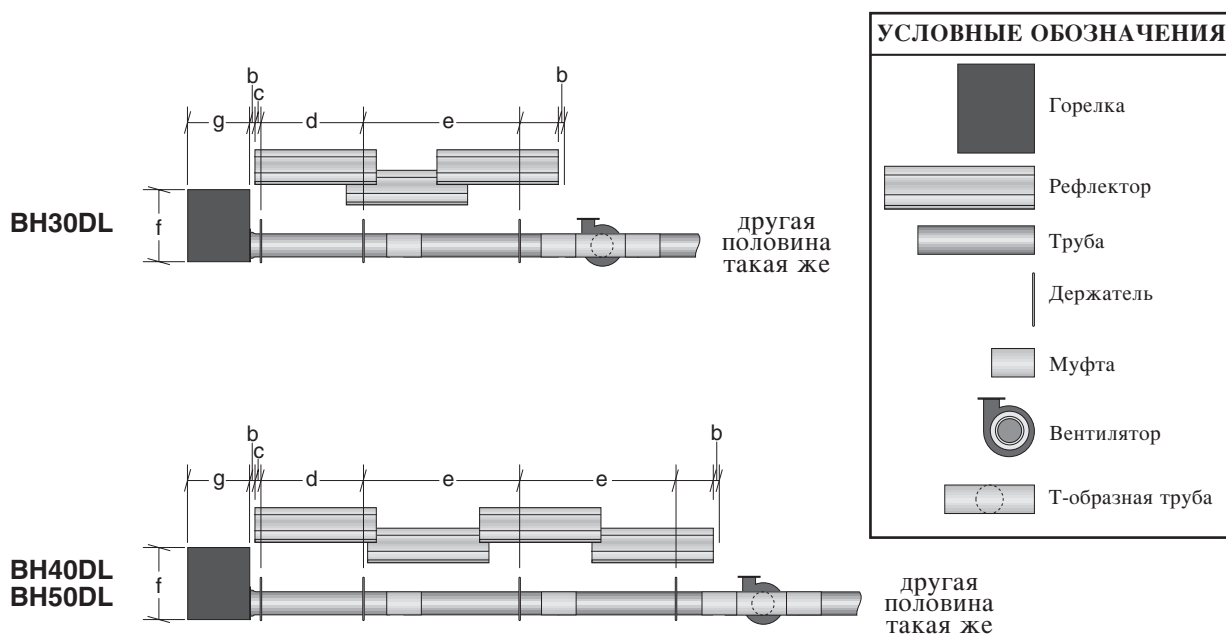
BLACKHEAT® Чертежи двойного линейного обогревателя
